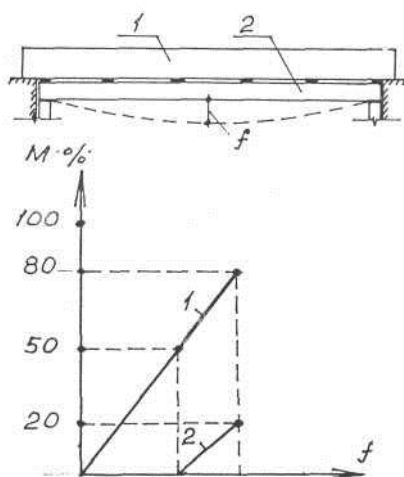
(1 — железобетонная балка, 2 — стальная балка)
